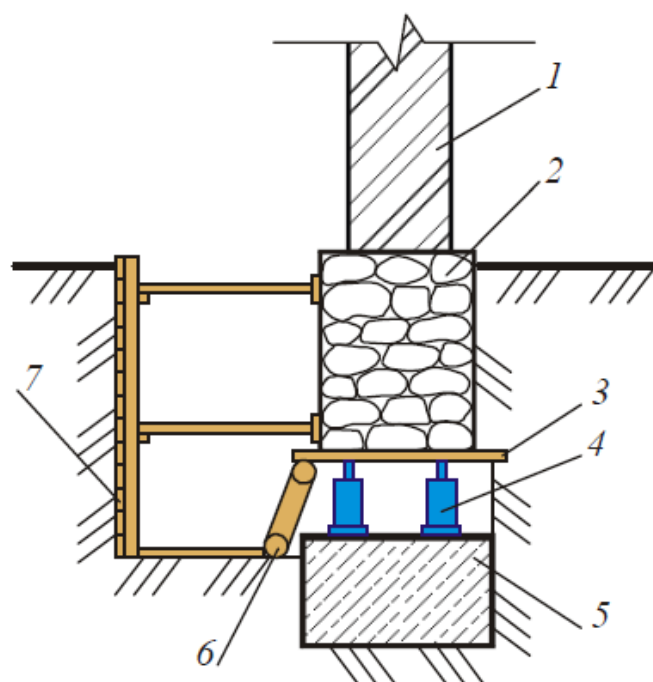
Углубление фундамента отдельными блоками: 1-стена; 2-фундамент; 3-забирки; 4-домкрат; 5-бетонный блок; 6-деревянная рама; 7-инвентарные щиты
